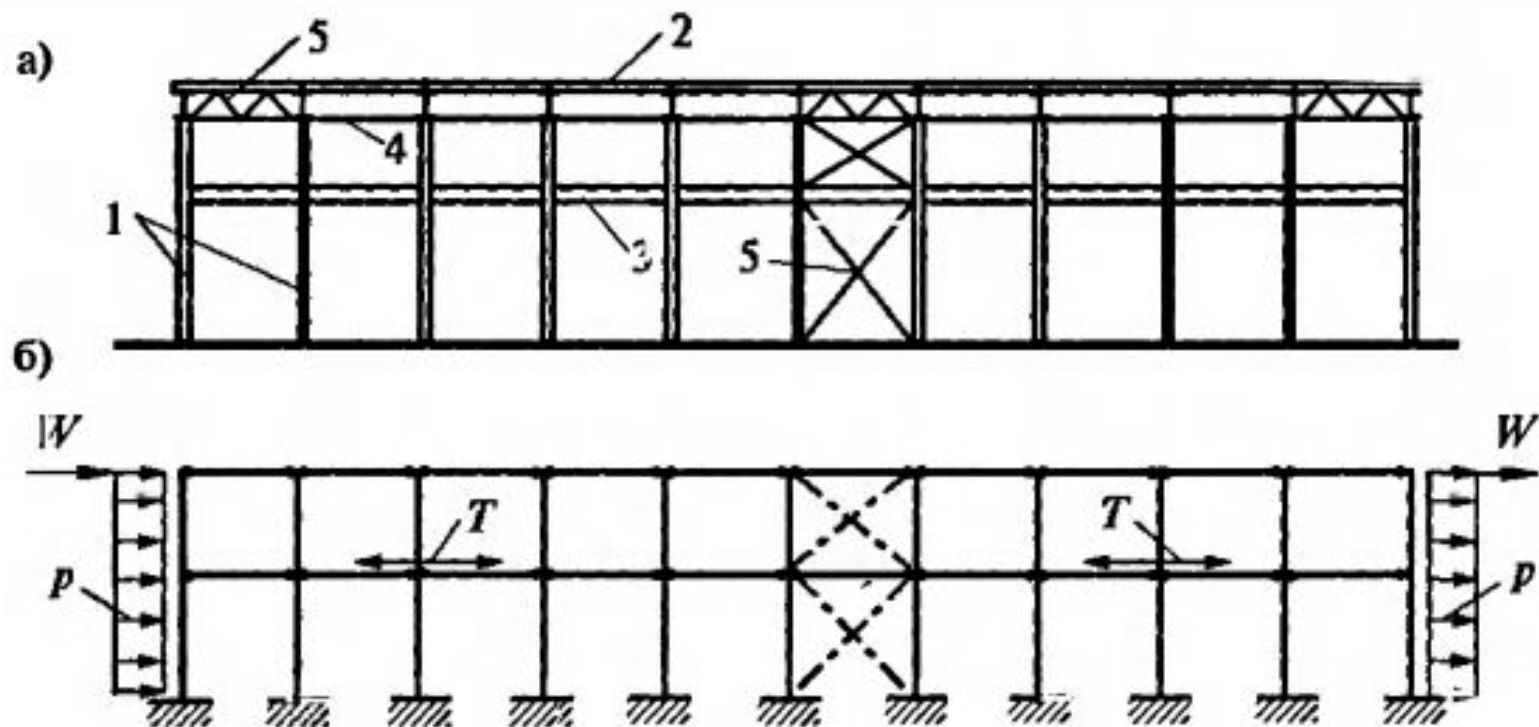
Продольная рама: а) конструктивная схема; б) расчетная схема продольной рамы; 1 — колонна; 2 — плита покрытия; 3 — подкрановая балка; 4 — распорки; 5 — вертикальные связи
